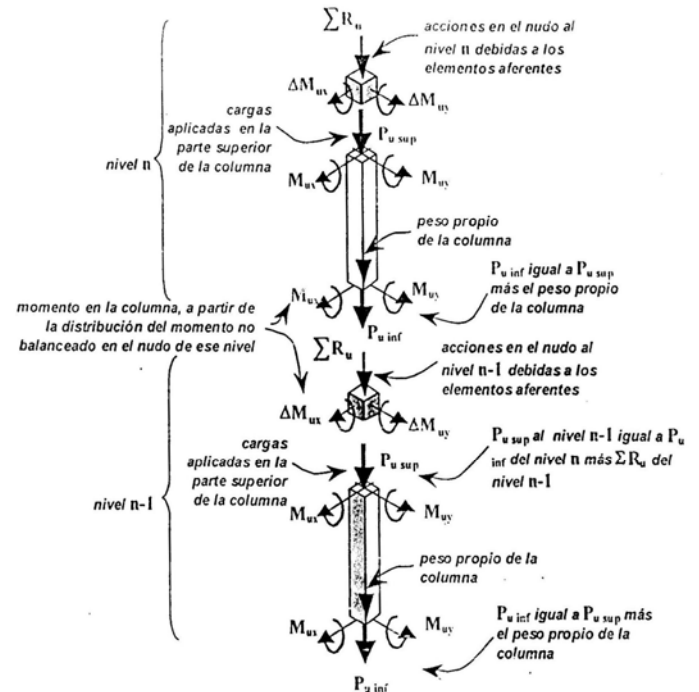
Transmisión de cargas de las vigas y nudos hacia una columna⁸.
